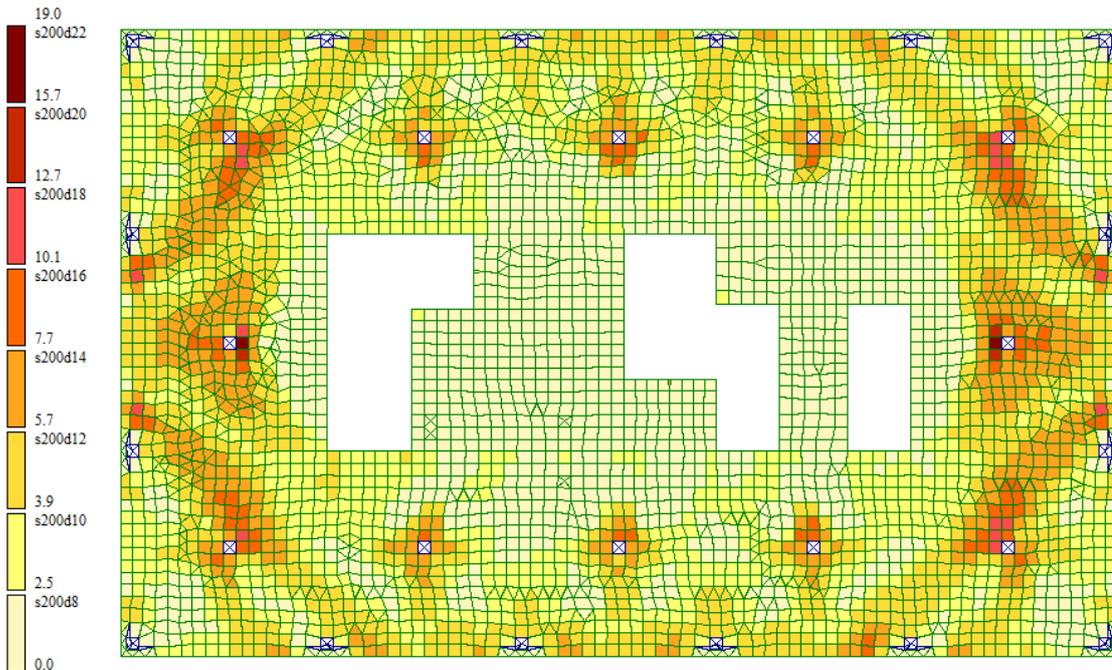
Схема армирования низа плит перекрытий по оси OX
